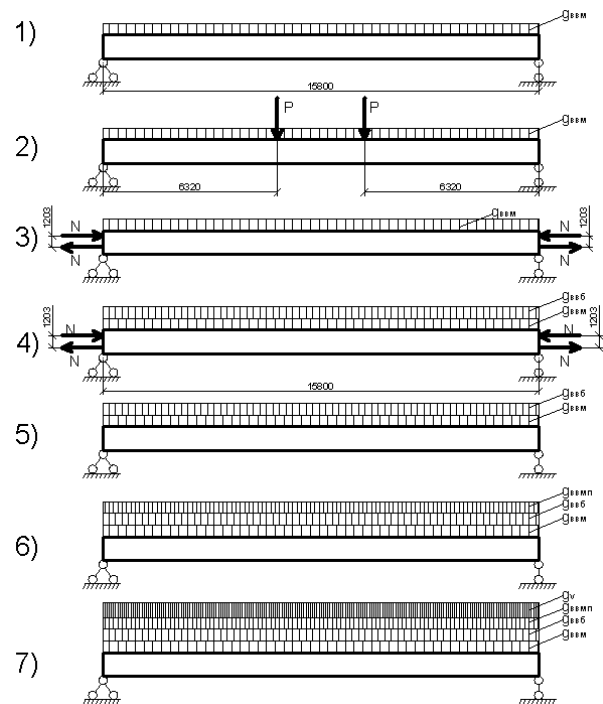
Розрахункові схеми та етапи навантаження сталезалізобетонної балки
